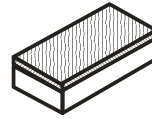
Área de colocación del mortero en mampuestos.
